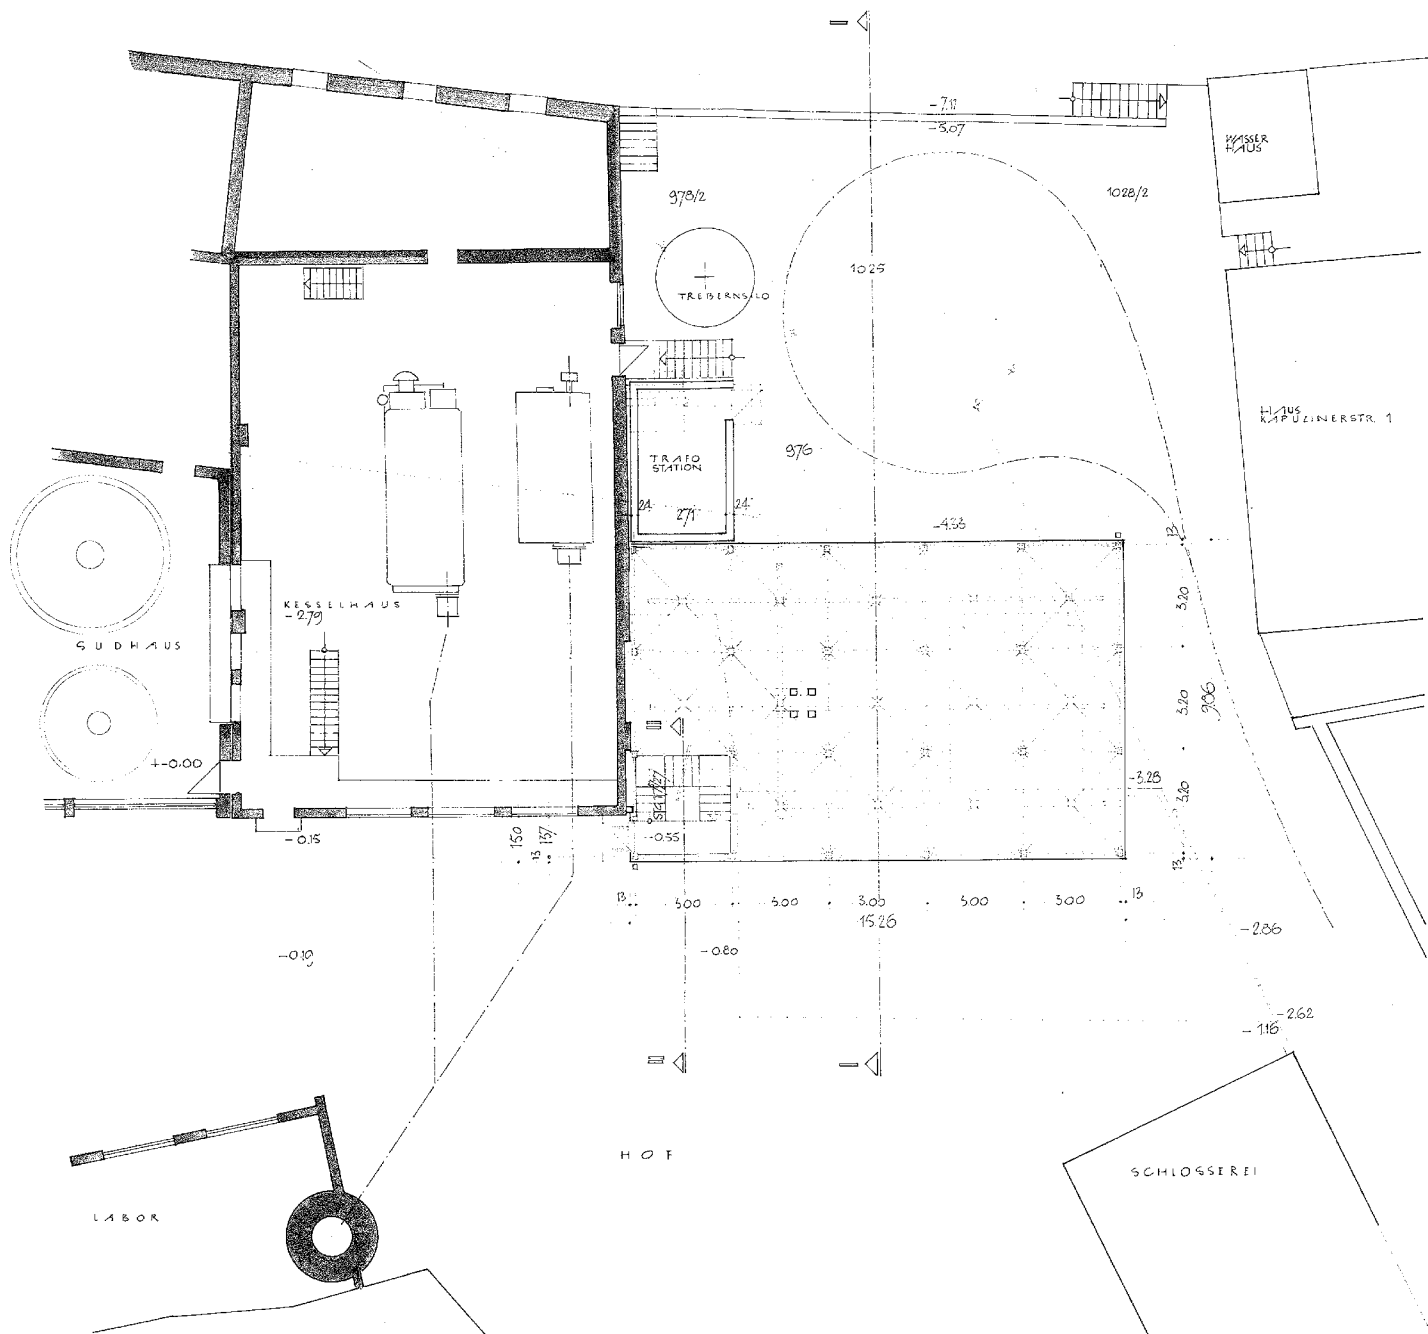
1972 Eingabeplan Neubau Silo statt Traföhäusern, Grundriss, nicht ausgeführt
